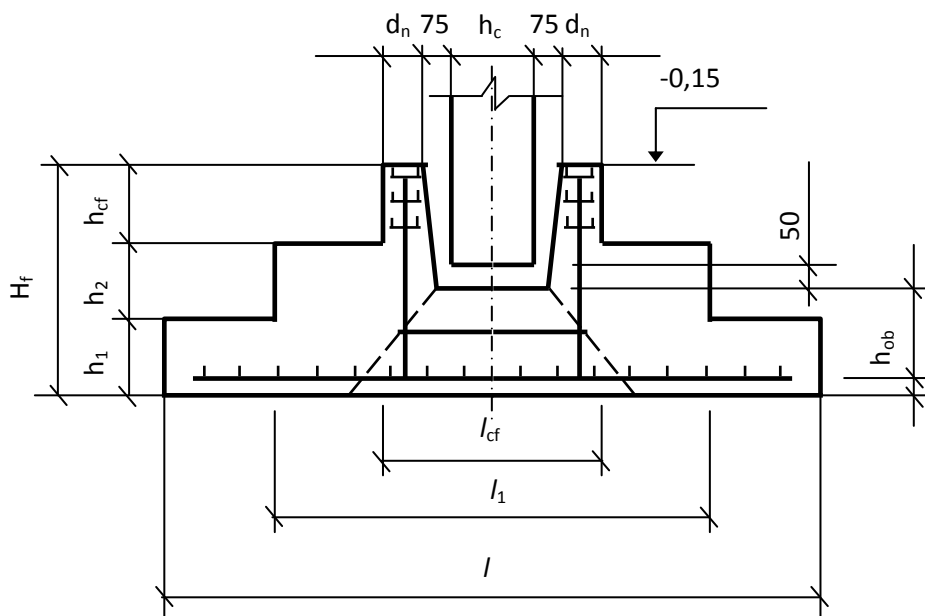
Конструкція фундаменту під збірну колону без підколонника
